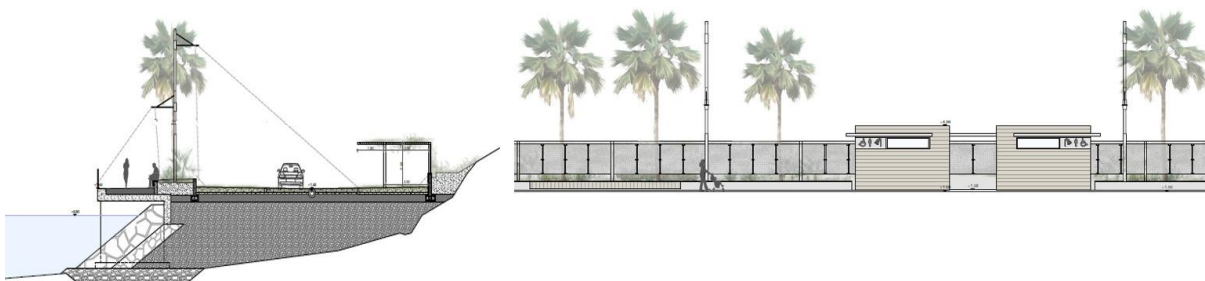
Sezione e dettaglio prospetto sud (Elaborati "D-AR-PR-026-0" e "D-AR-PR-025-0")
